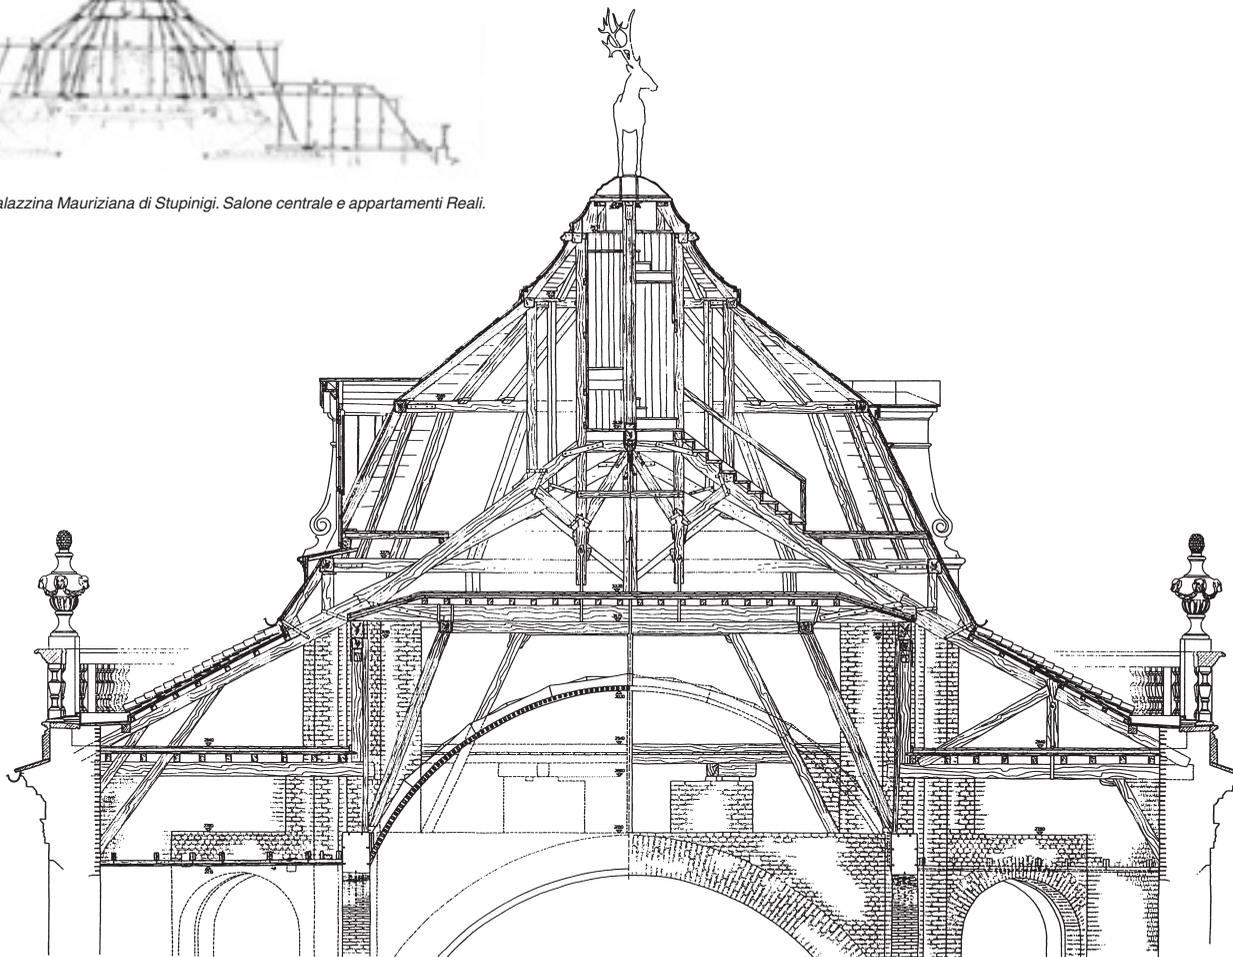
Stupinigi. Fondazione Palazzina Mauriziana di Stupinigi. Salone centrale e appartamenti Reali. Sezione trasversale della copertura
